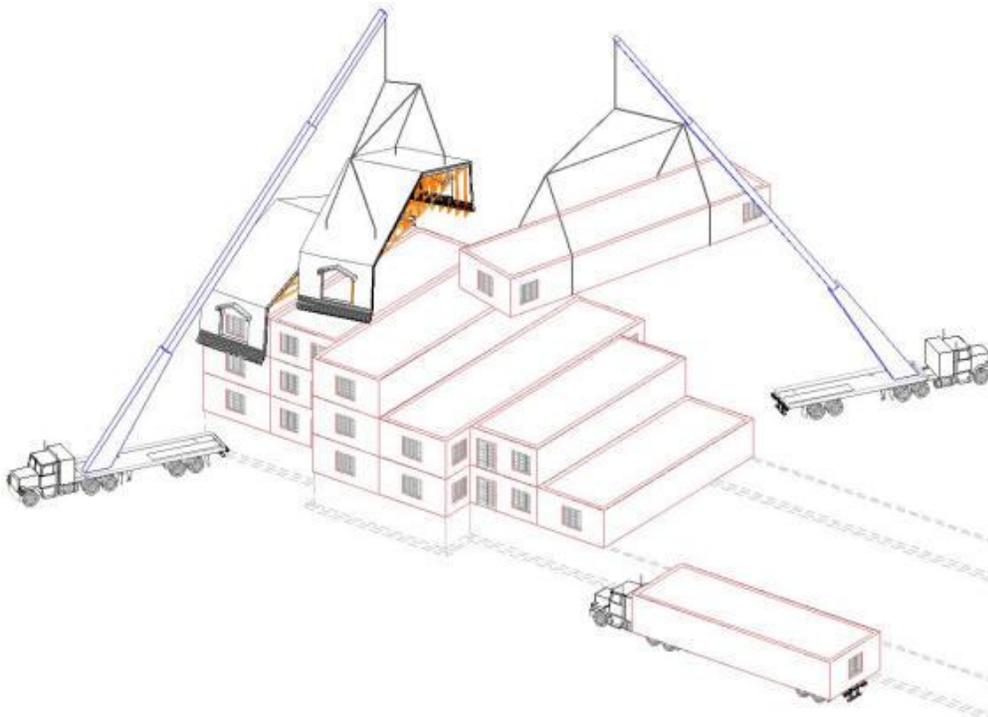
Installation et assemblage des modules usinés sur fondation et de la toiture sur les modules⁵
